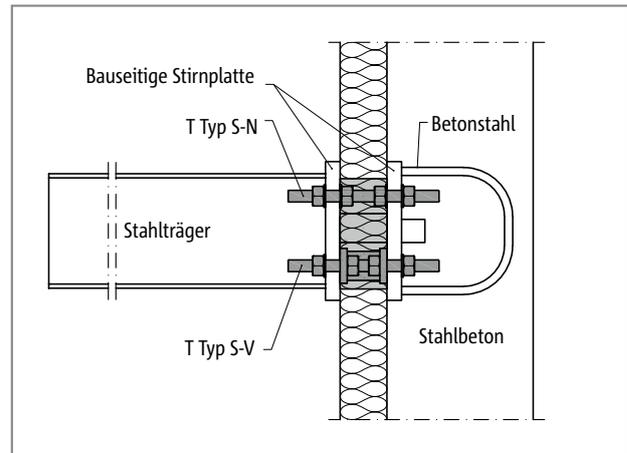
Schöck Isokorb® T Typ S-N und T Typ S-V: Anschluss Stahlkonstruktion an Stahlbeton
